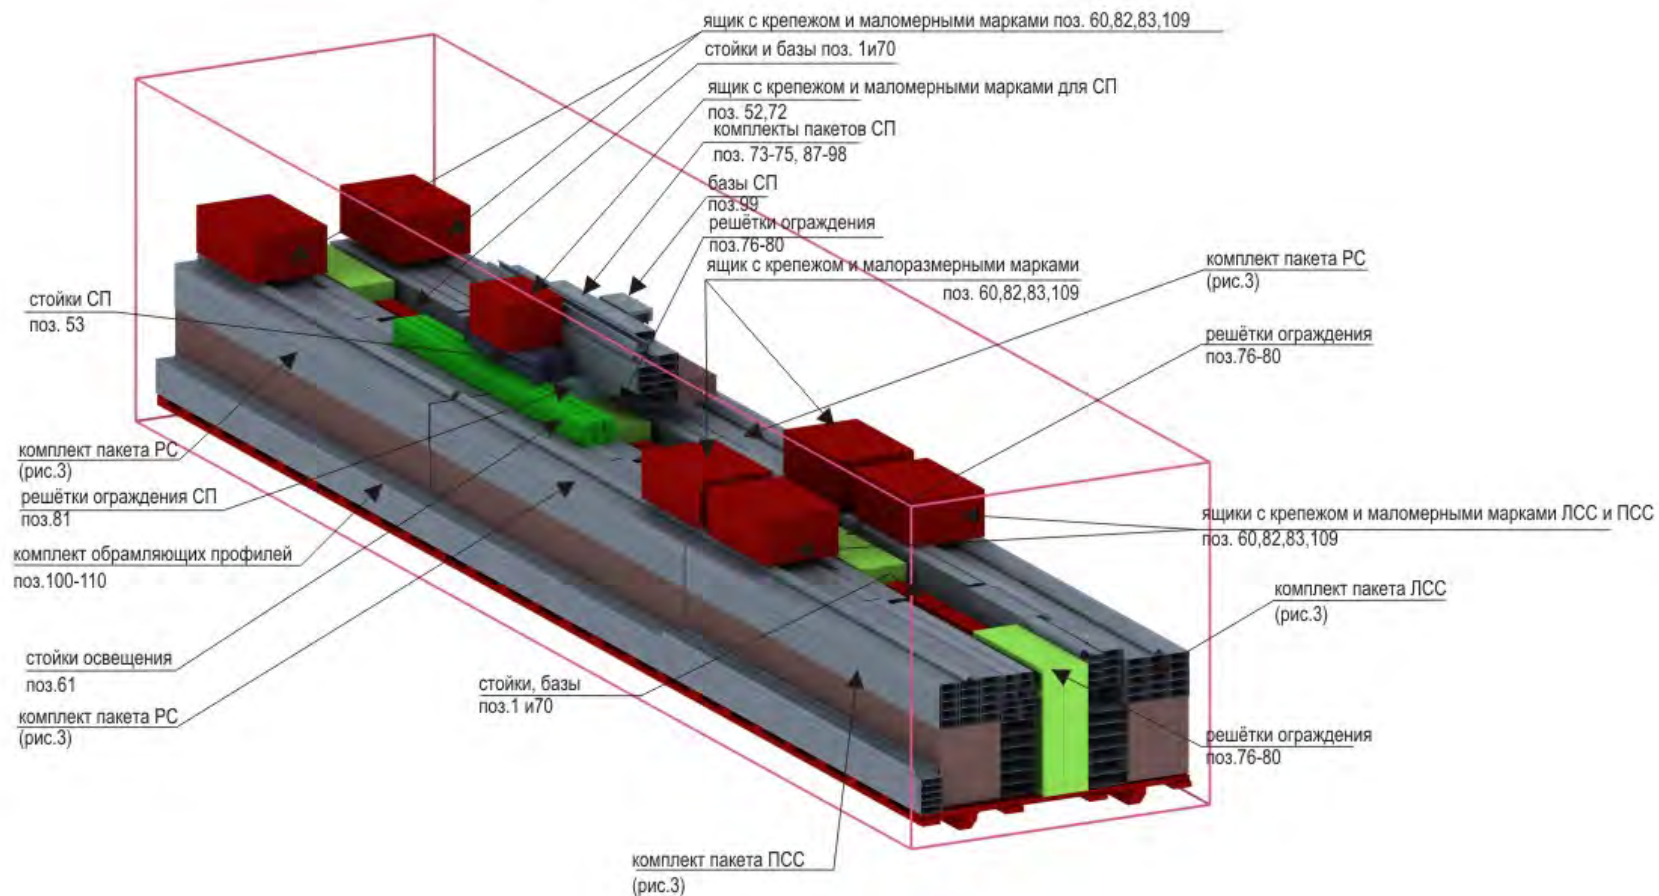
Схема упаковки на паллет конструкций платформы ПУМА 264-4-1.1-ДПК. Контейнер № 3.
